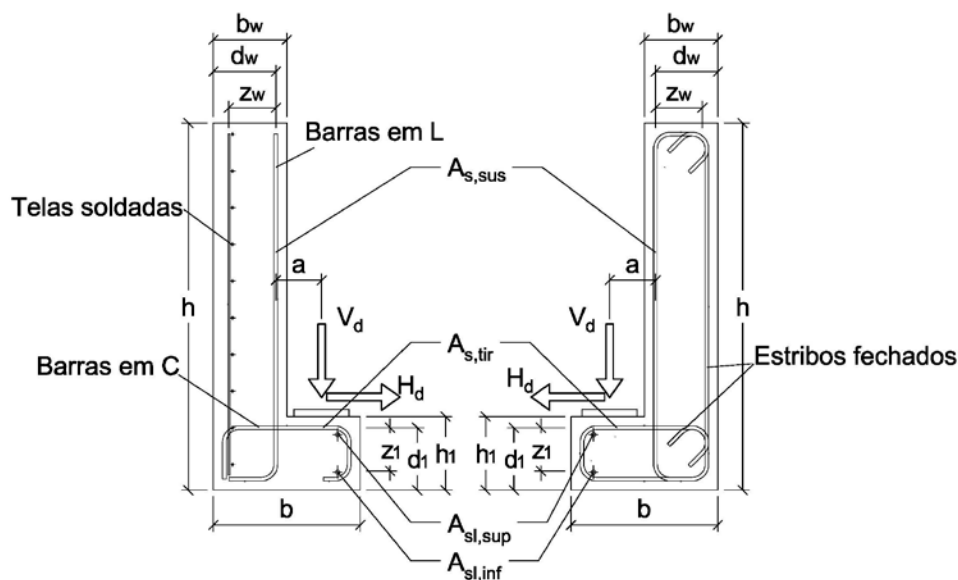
Geometria e armadura necessária para aba/mesa inferior.
